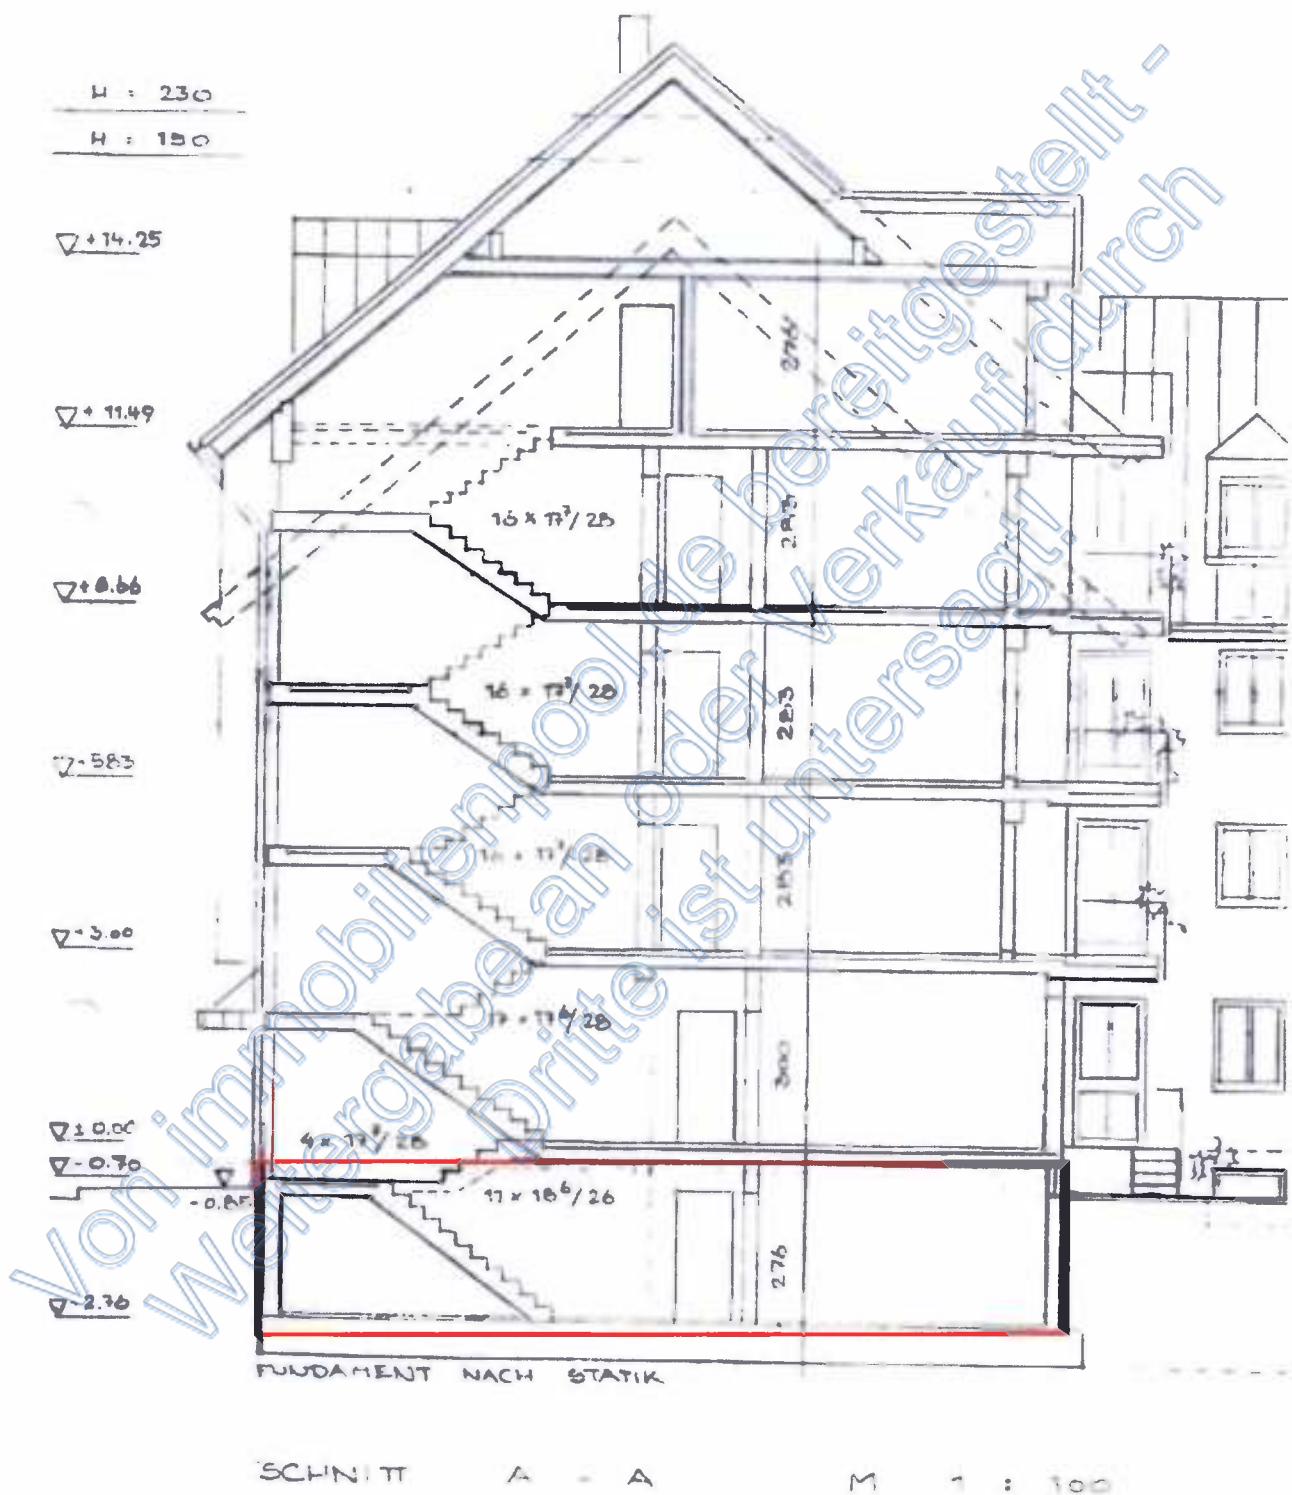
Gebäude Schnitt (ohne Maßstab) Plan Roteintragung d.d. SV: schematische Lage der Einheit Nr. 2
